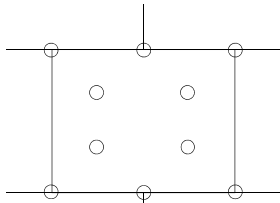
Panneaux PTP-S-035 de dimensions 800 × 625 mm - plans de chevillage en plein
